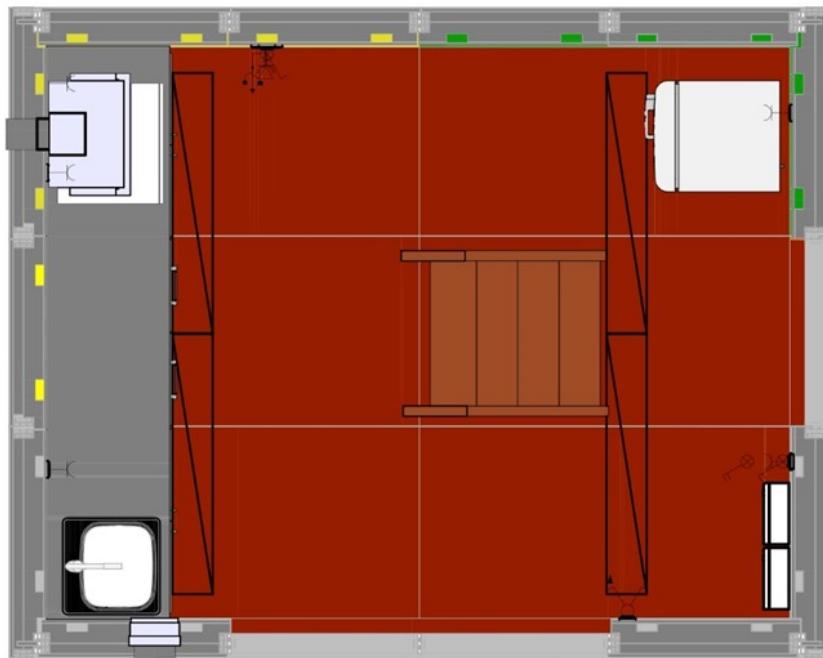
Planta Pios 0 do Protótipo – Metodologia BIM
